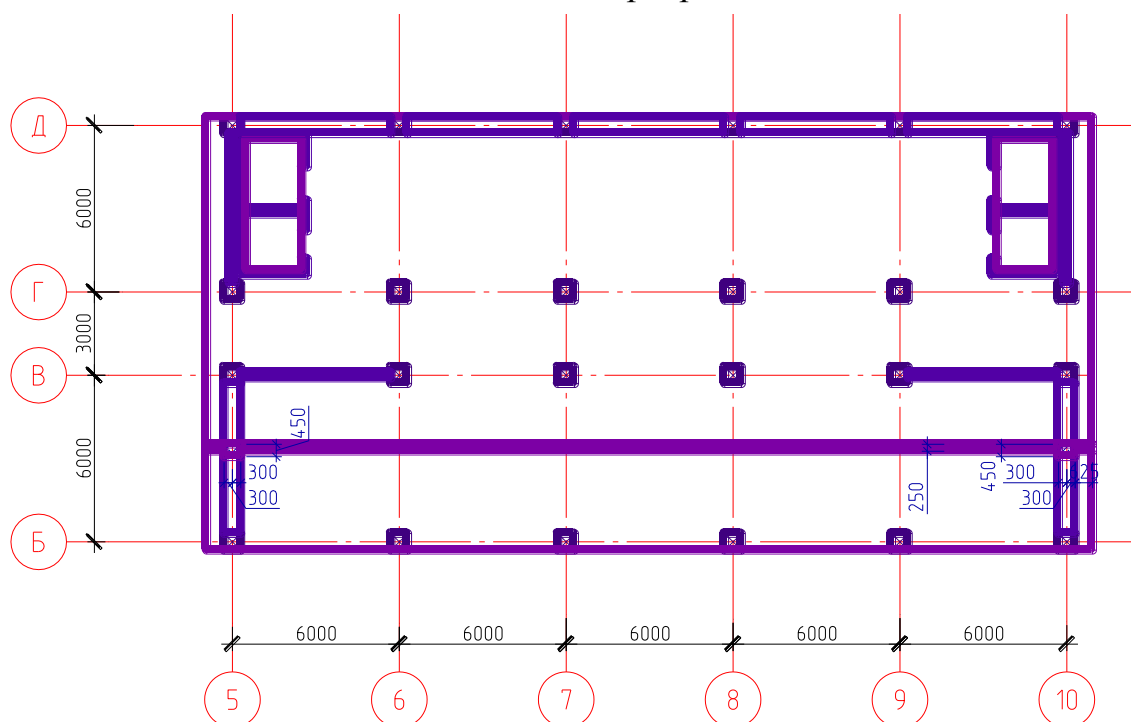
Расчетная схема монолитной плиты перекрытия.
